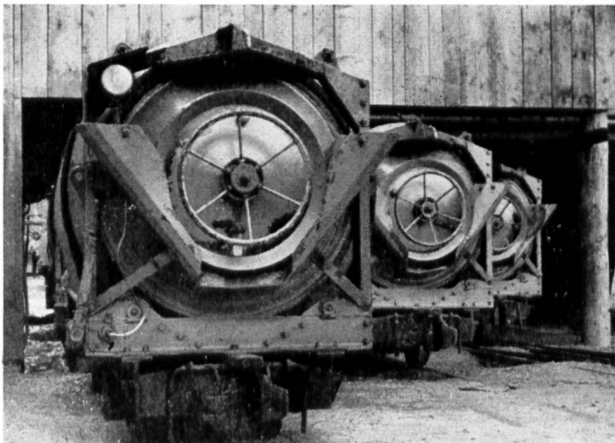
Betontransporttrommeln für je 2,5 m³ Beton
